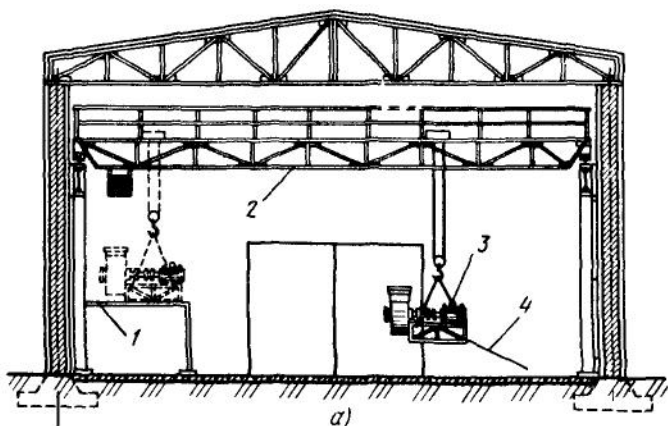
Подъем вентиляторов на площадку с помощью крана:
